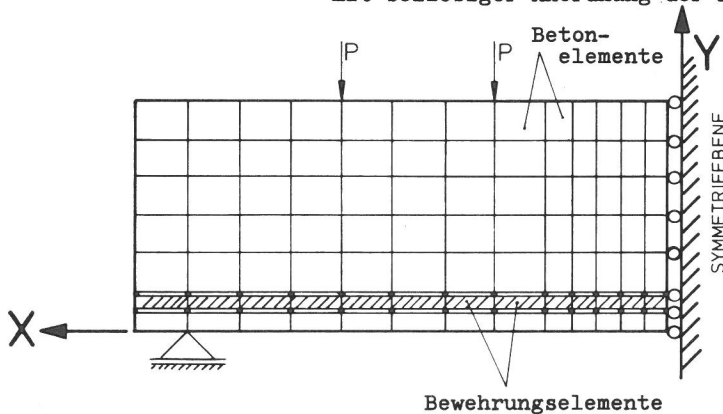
Finites Elementmodell eines Stahlbeton-Balkens - Abmessungen, Bewehrungsführung und Belastung symmetrisch zur Balkenmitte
